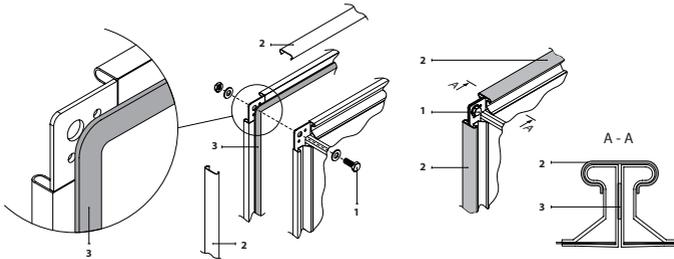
Exemple de fixation et d'étanchéité d'un raccordement de conduites à brides
